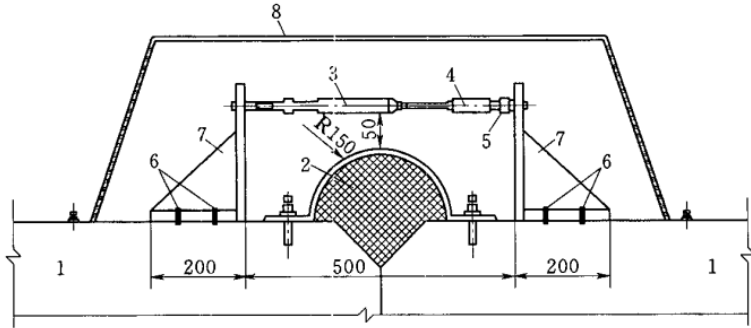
土位移计坑式埋设示意图 (单位: mm)
